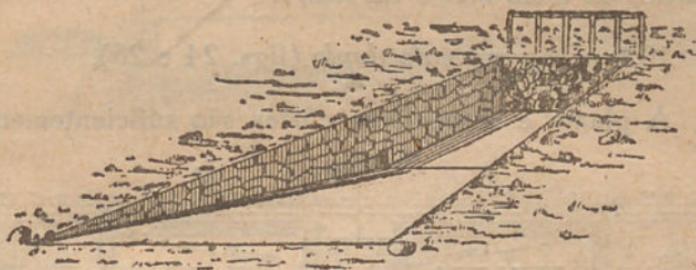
Estrumeira de rampa, em dois planos—Perspectiva
